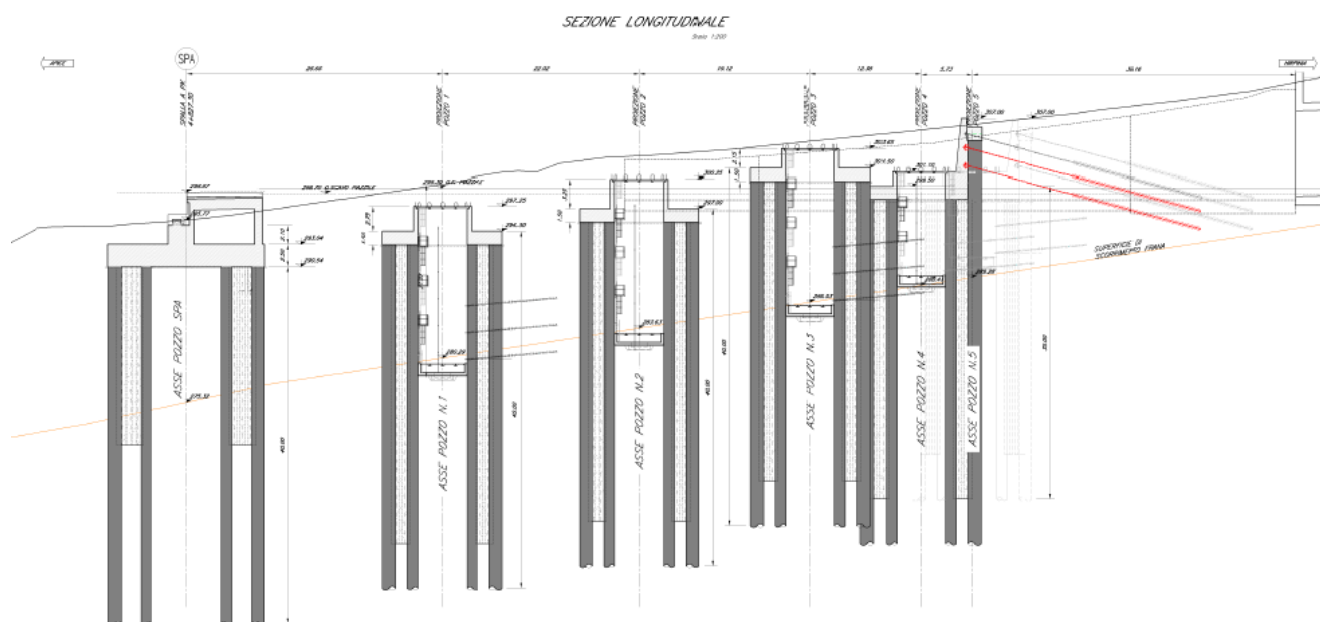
Sezione longitudinale: Disposizione altimetrica dei pozzi strutturali P1-P5
